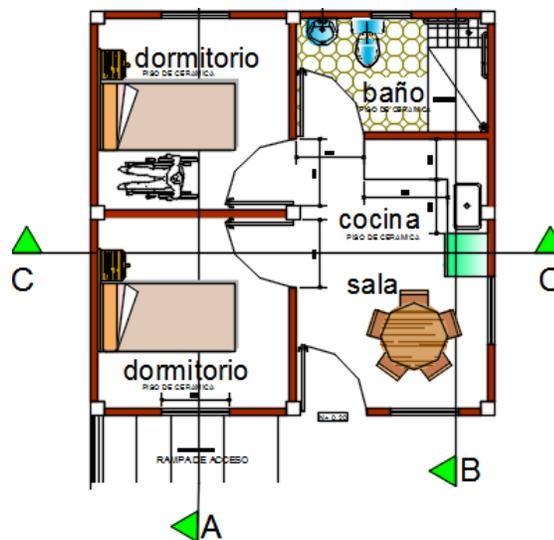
Planta arquitectónica vivienda MIDUVI año 2012.
